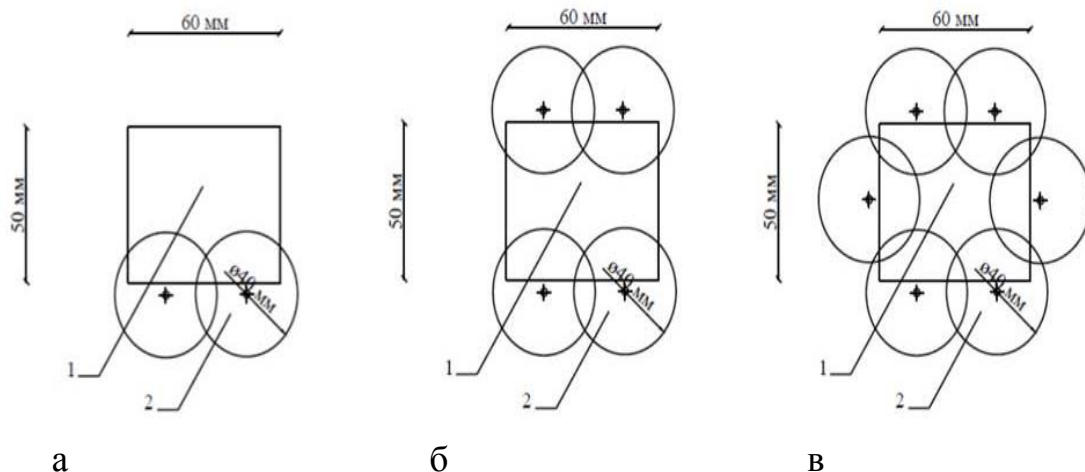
Схемы расположения свай в плане: а) 2 сваи; б) 4 сваи; в) 6 свай: 1 - штамп; 2 - сваи
